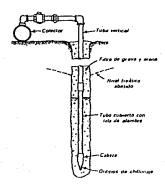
DETALLES DE UN POZO DE PUNTA.
